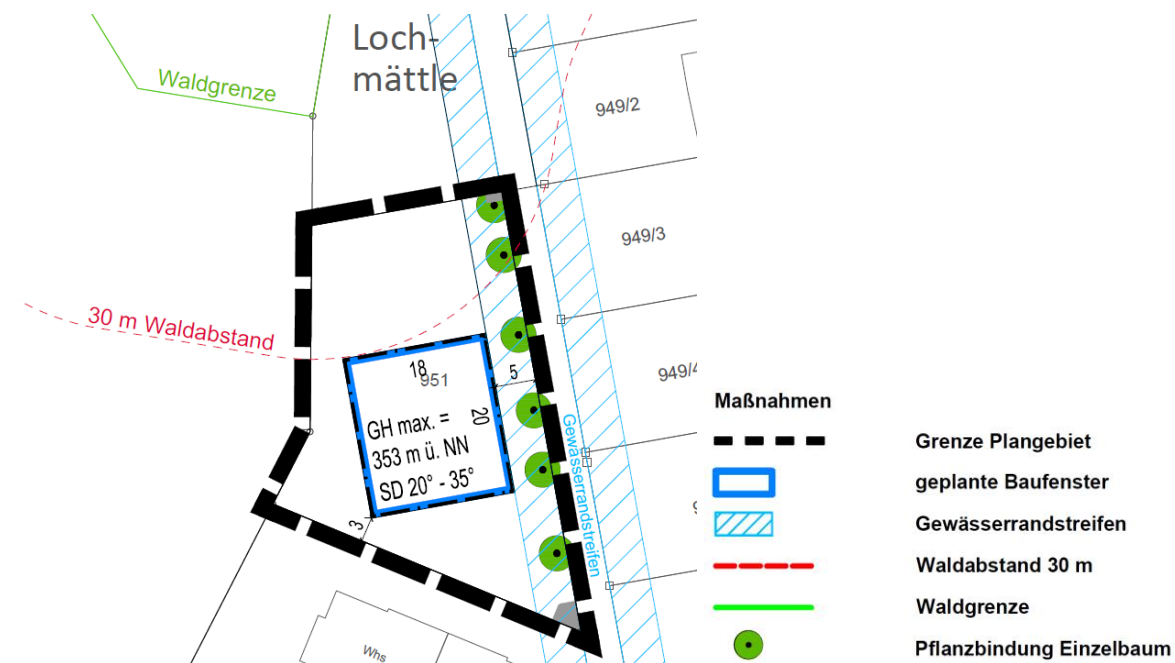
Maßnahmenplan (Quelle: galaplan decker, Stand 27.05.2025)
